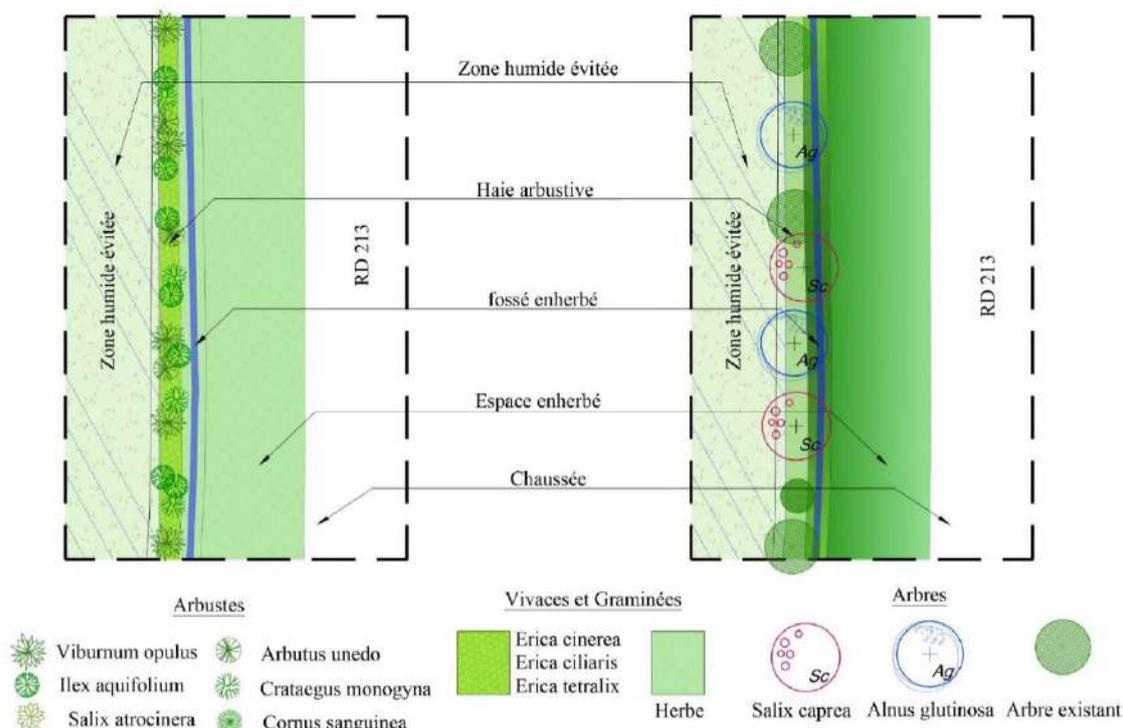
Plantations sur les lisières de la zone humide dans la pointe Sud du site
